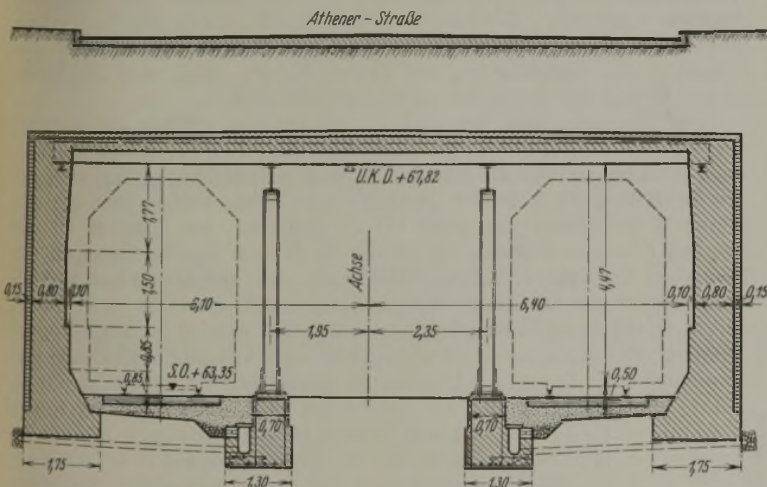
Offener Tunnelquerschnitt südlich Omoniaplatz.
